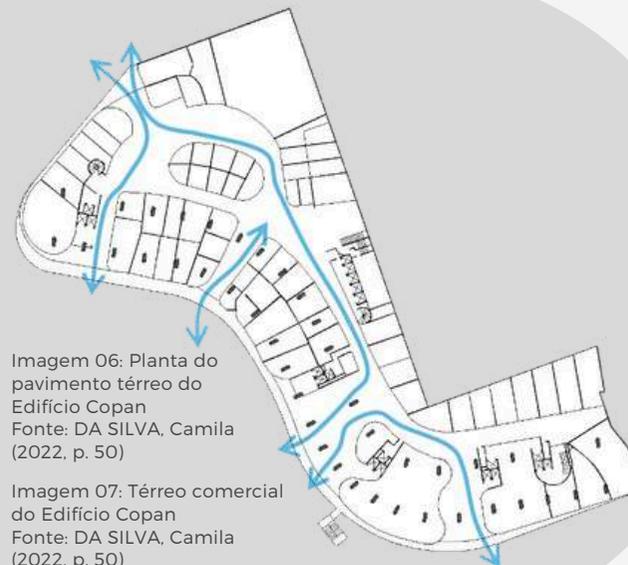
Planta do pavimento térreo do Edifício Copan
